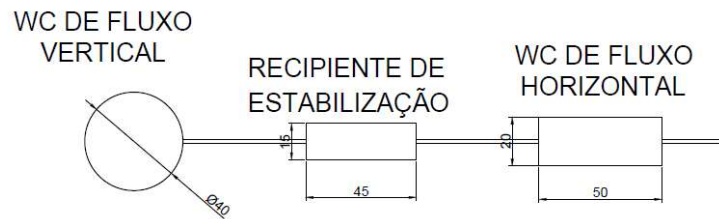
Vista em planta do modelo de tratamento com as dimensões estimadas.
